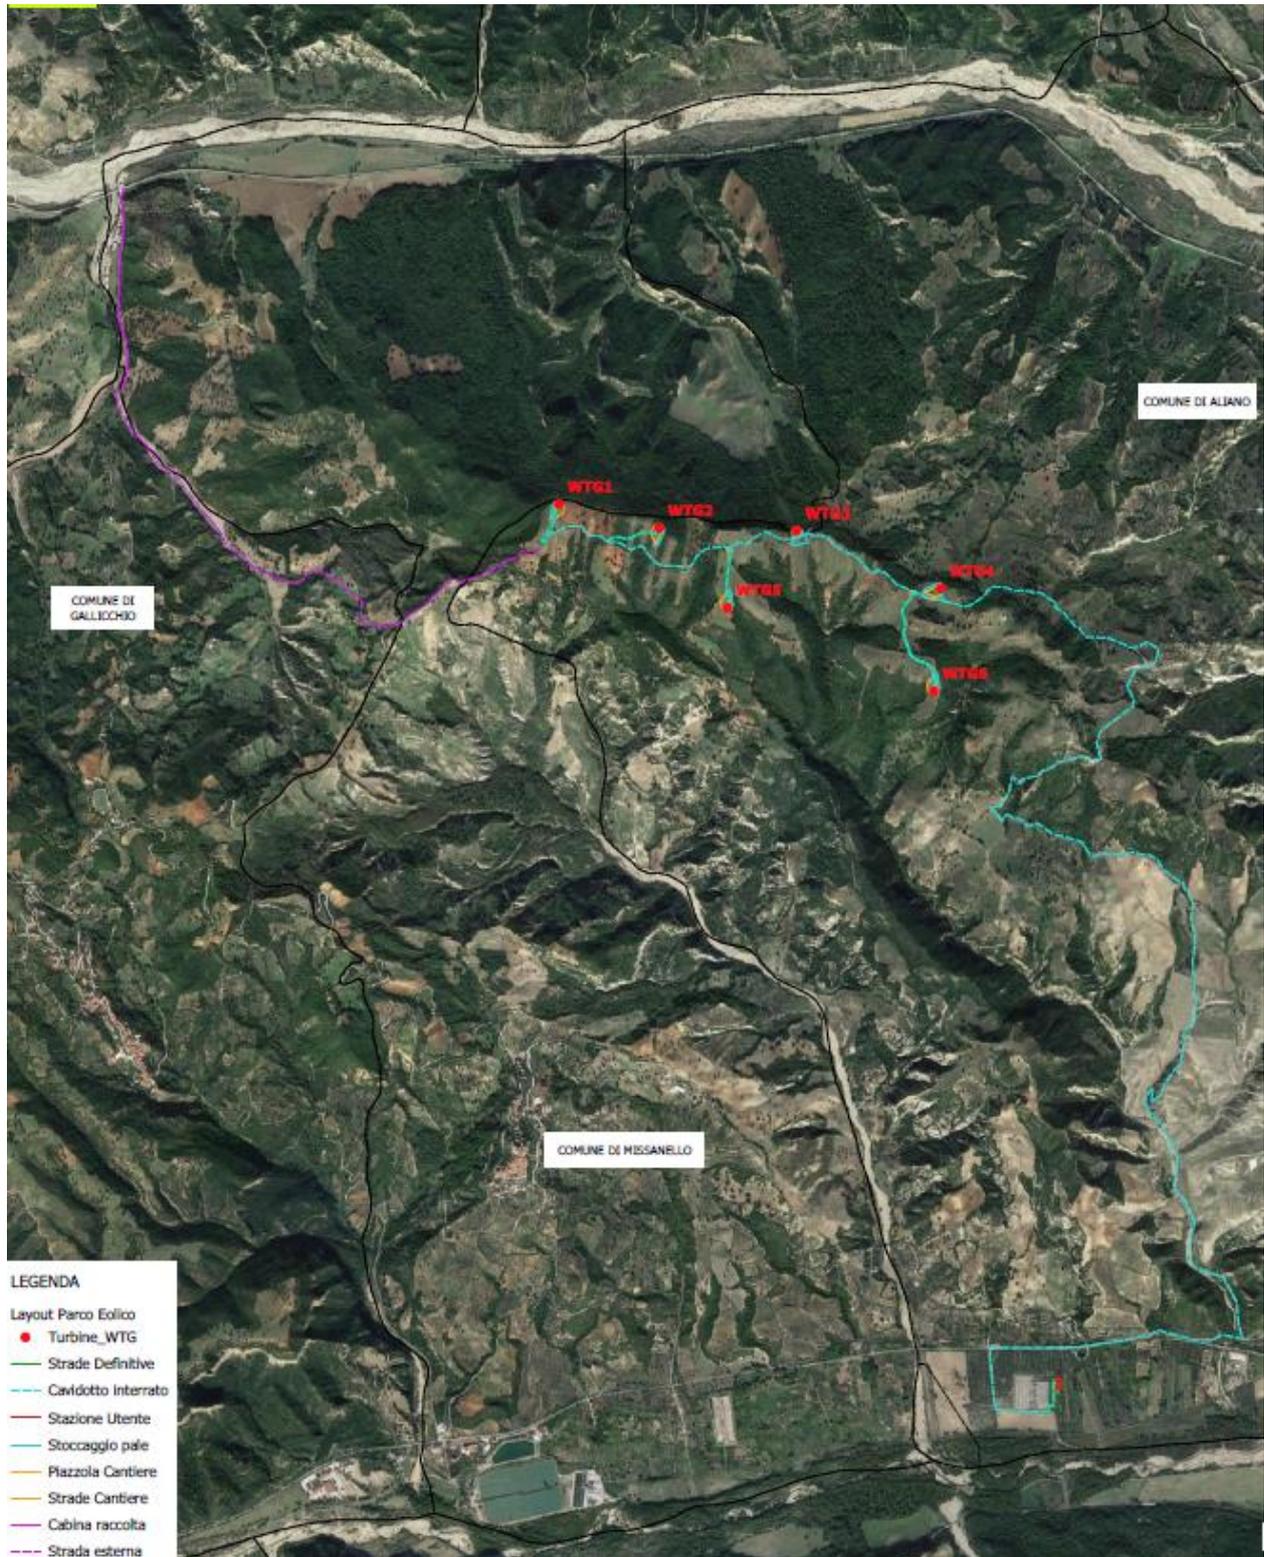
Area di intervento: dettaglio layout di progetto su ortofoto
